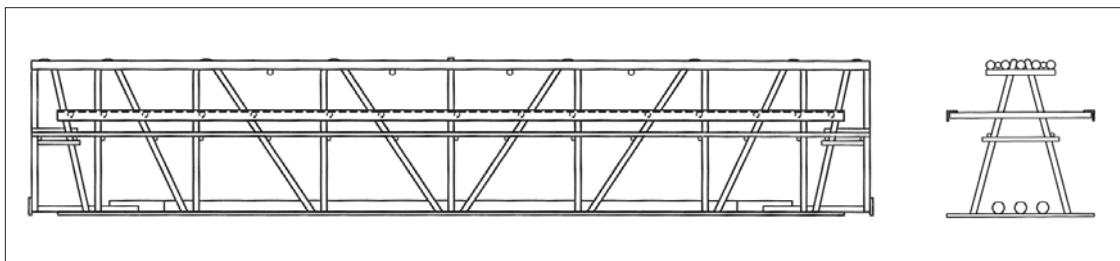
Vista laterale e sezione trasversale trave con fondello in acciaio.
